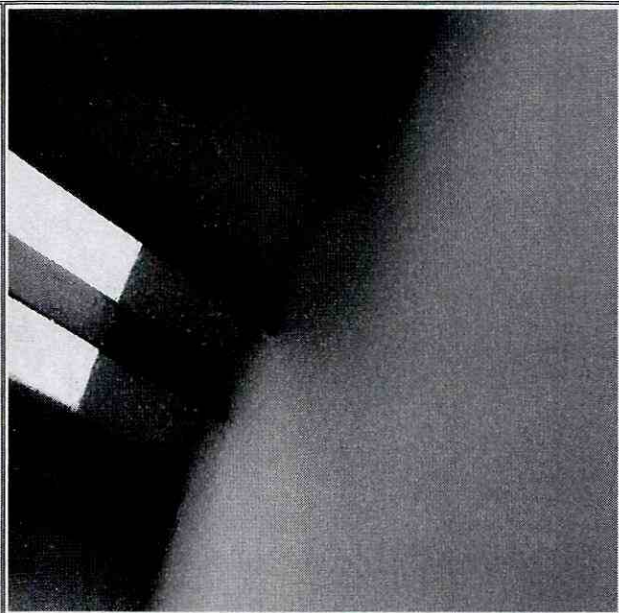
Afectaciones en el sector de la cubierta de la vivienda
